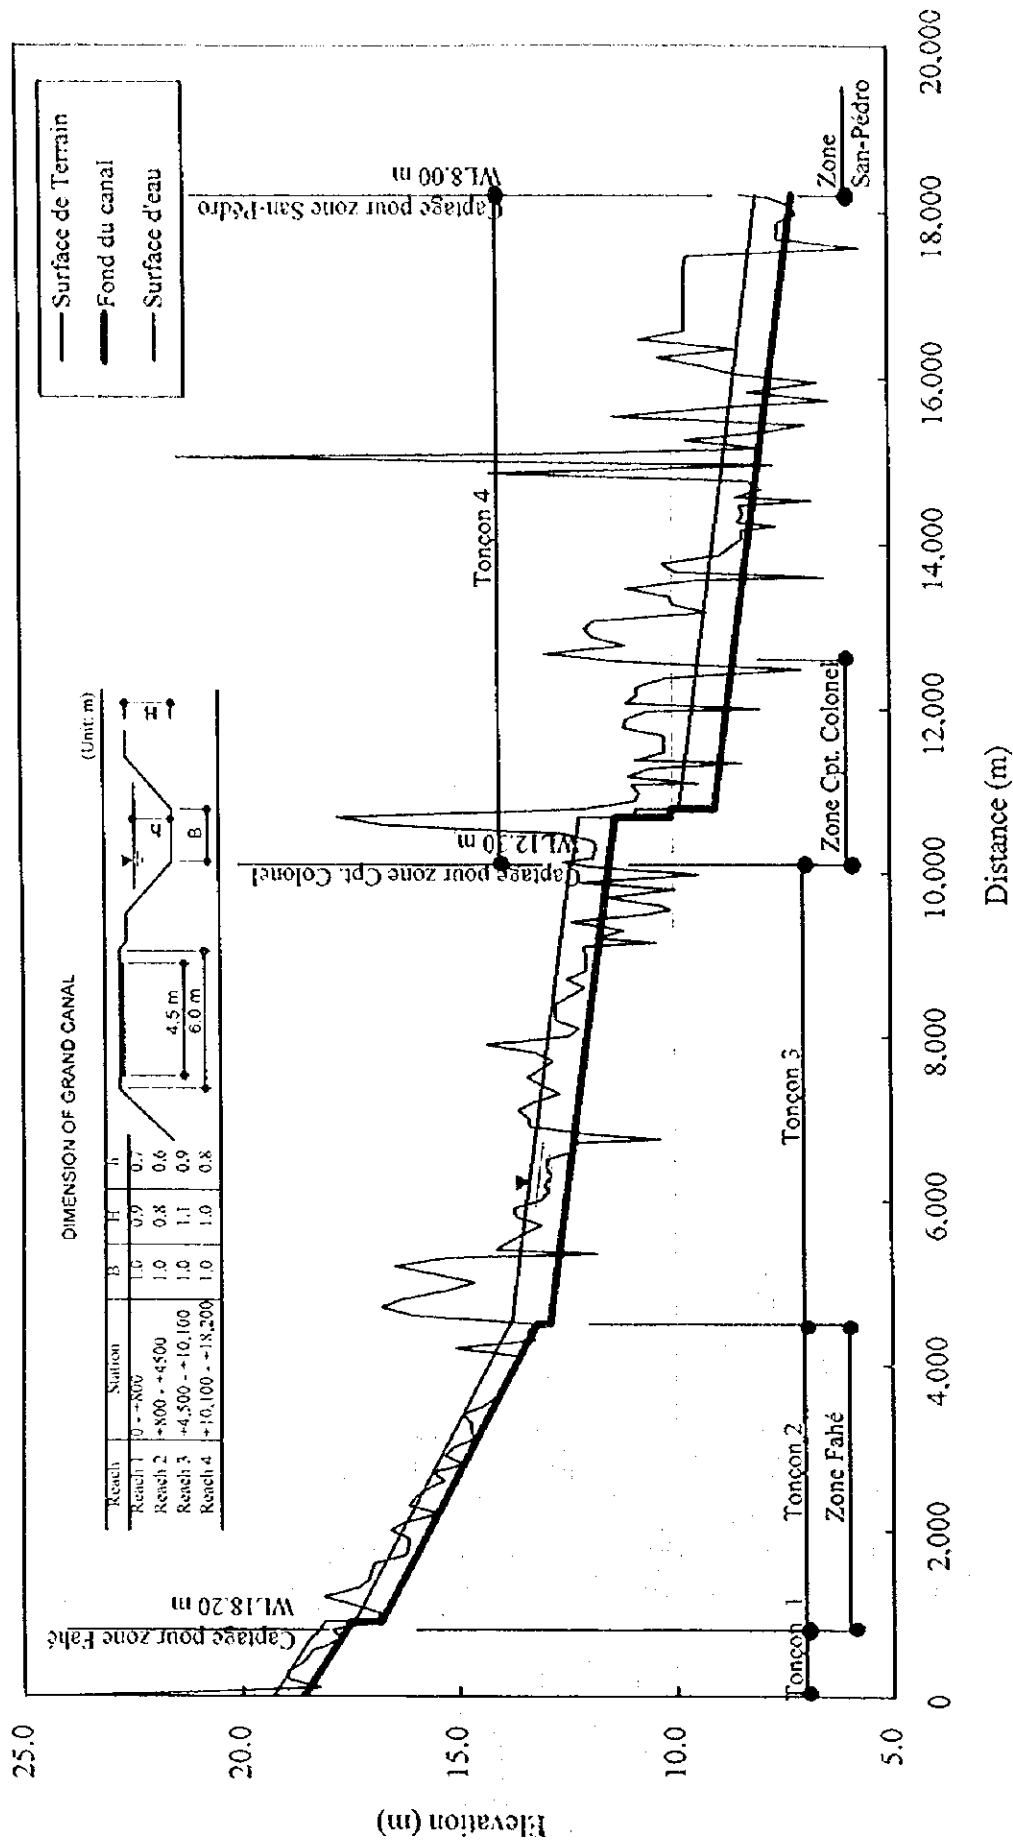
Profil longitudinal et section du Grand canal
